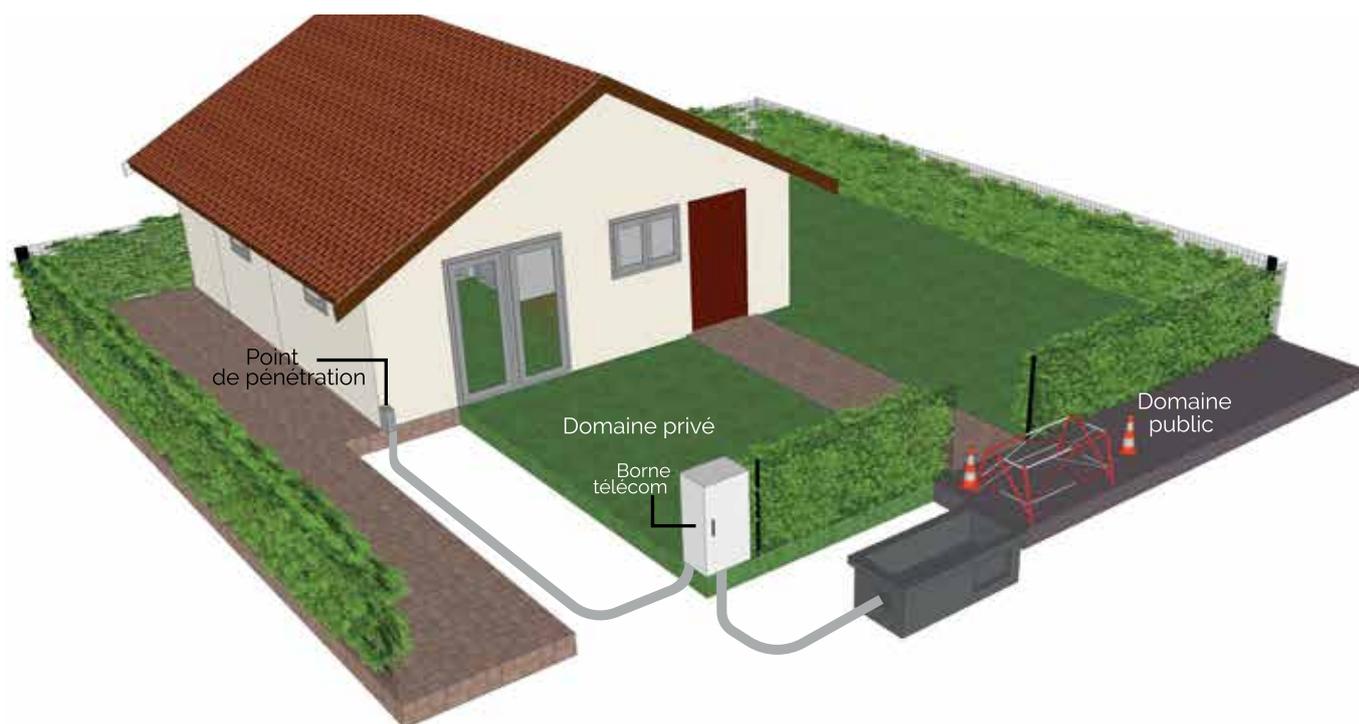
| cas d'un branchement à partir d'un lien pré-installé en attente au PDO ou dans la boîte de jonction murale
